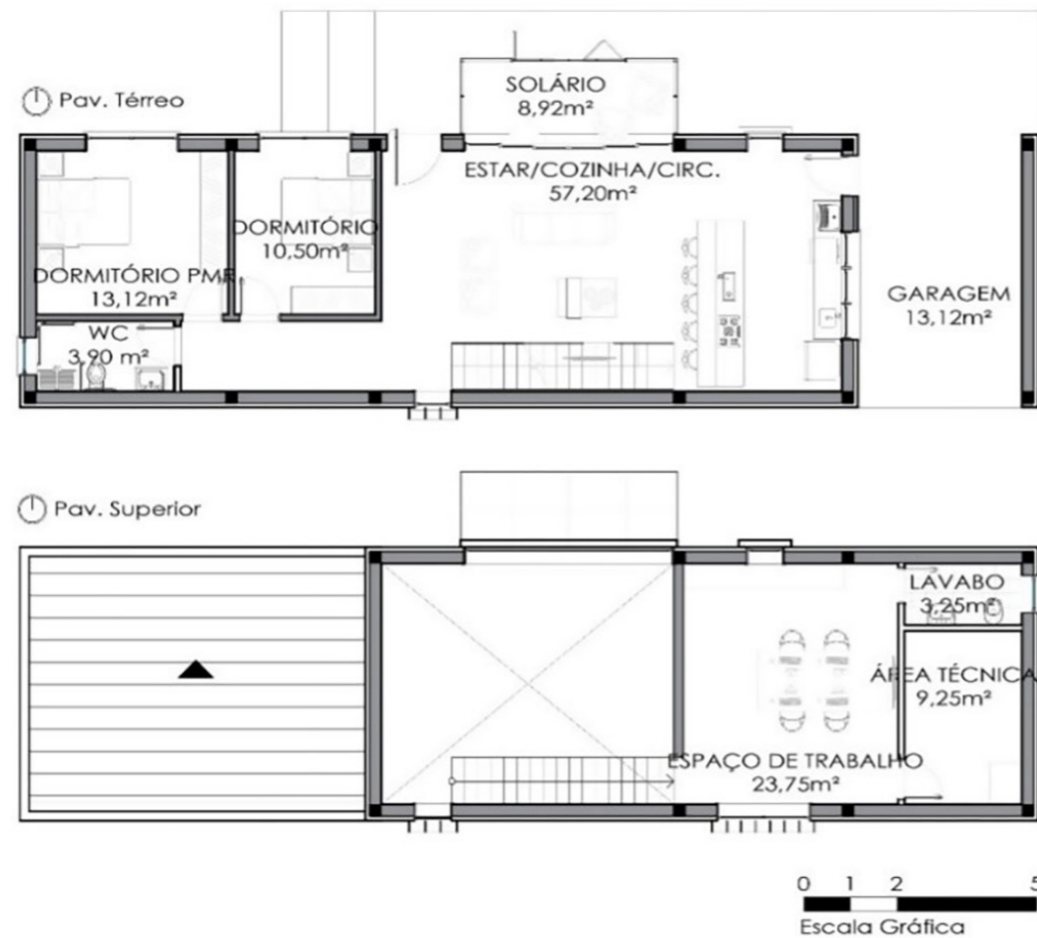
Planta baixa dos pavimentos térreo e superior. Fonte: (Dalbem, 2015).
